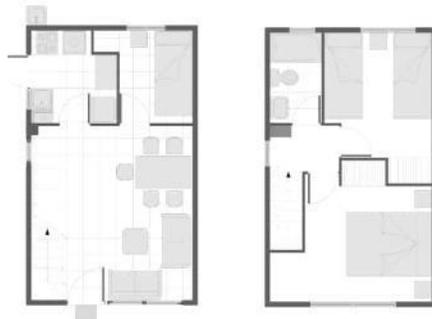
Planta primer y segundo niveles - Proyecto Monte Verde II
